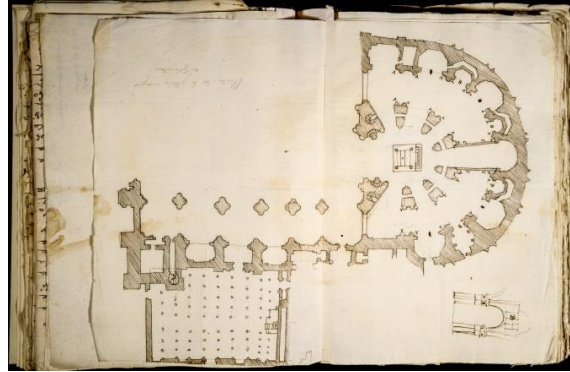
جامع قرطبة، مسقط أفقي، عن:
